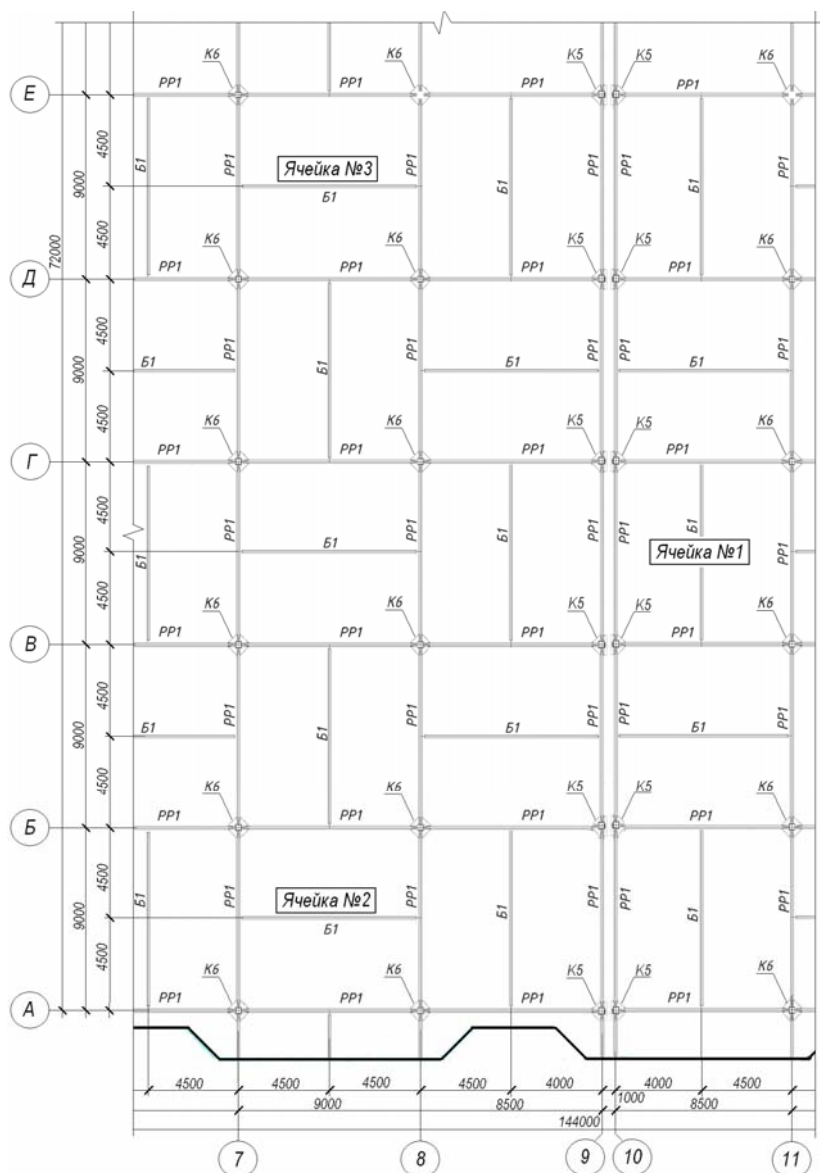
Фрагмент плану будівлі з вказанням ячеек, в яких проводилися випробування
